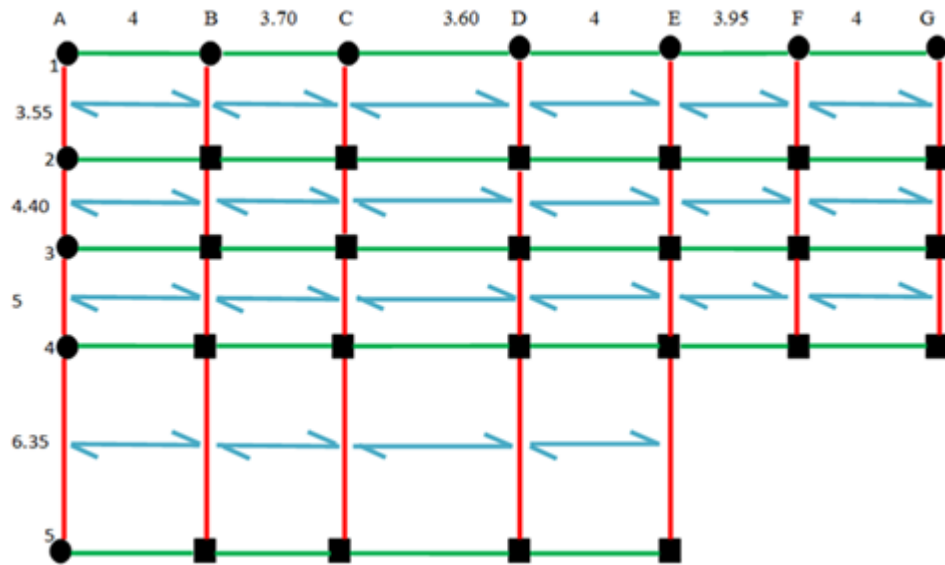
disposition de poutrelle plan étages de la galerie commerciale et sous-sol 1,2
